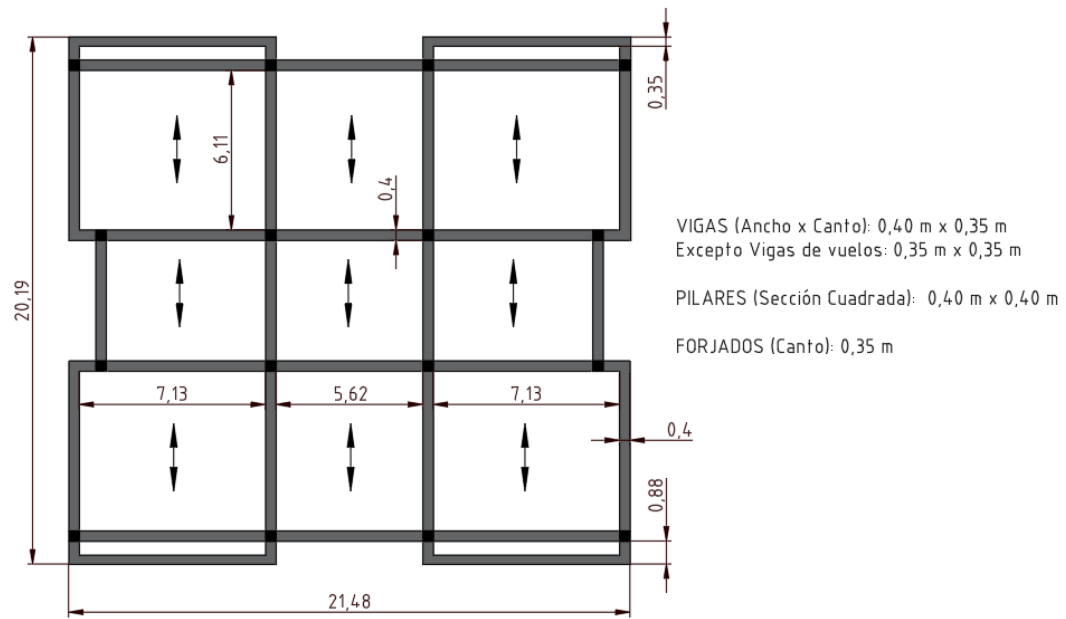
Plano de geometría de la planta de cubierta de la estructura.
